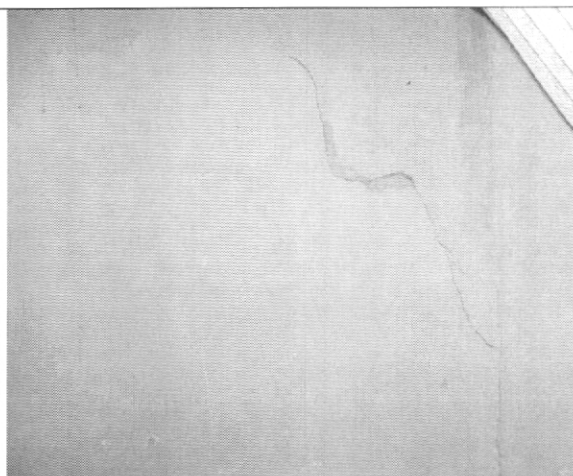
Detalle de una fisura en muro interior de la vivienda donde habita la familia del señor Reinaldo Posada.
